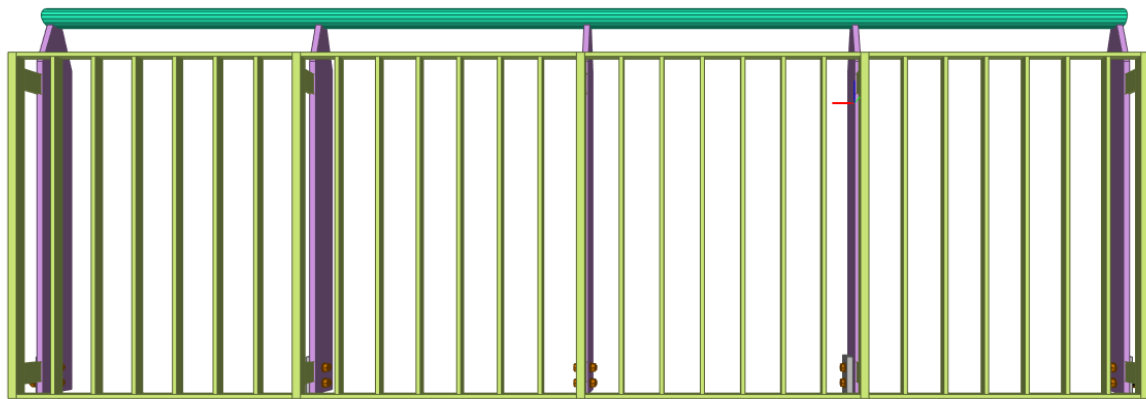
Ex-Galoppatoio – modello strutturale parapetto
